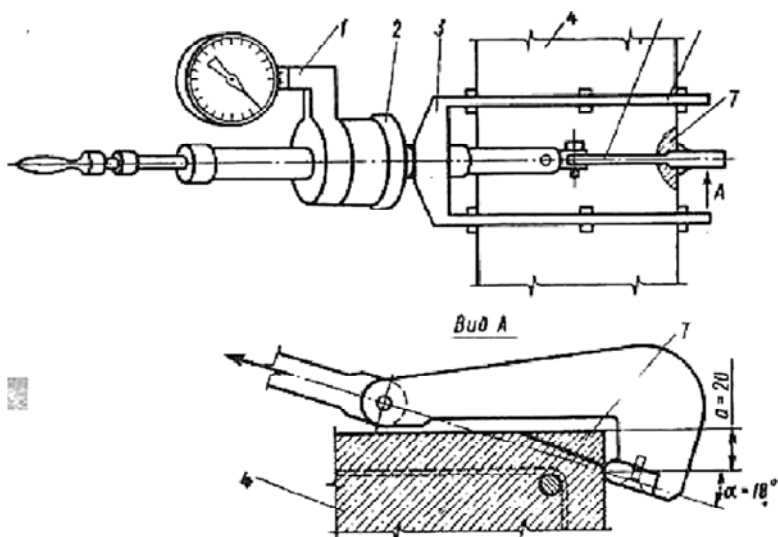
Схема испытаний методом скалывания ребра:
